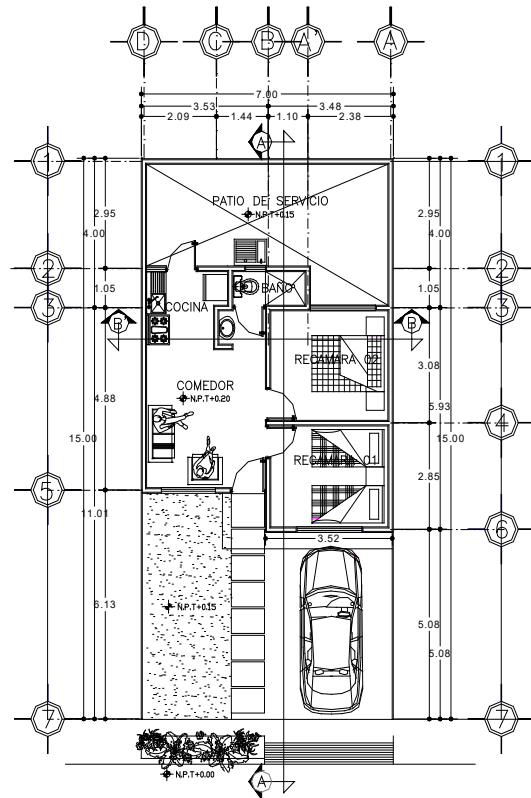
Planta arquitectónica de la vivienda-tipo del fraccionamiento Vida Mejor.
